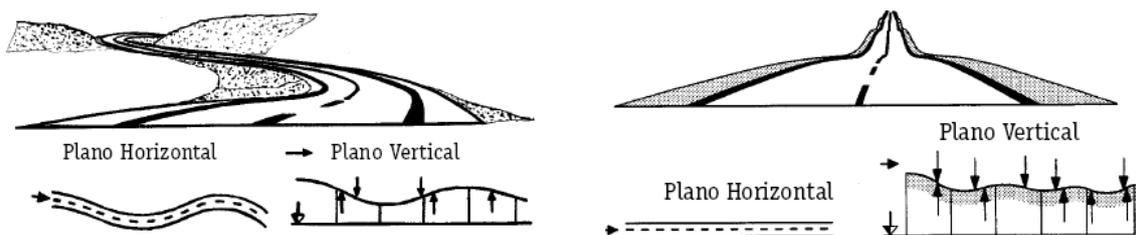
Concordância da estrada entre o plano horizontal e o perfil vertical.
